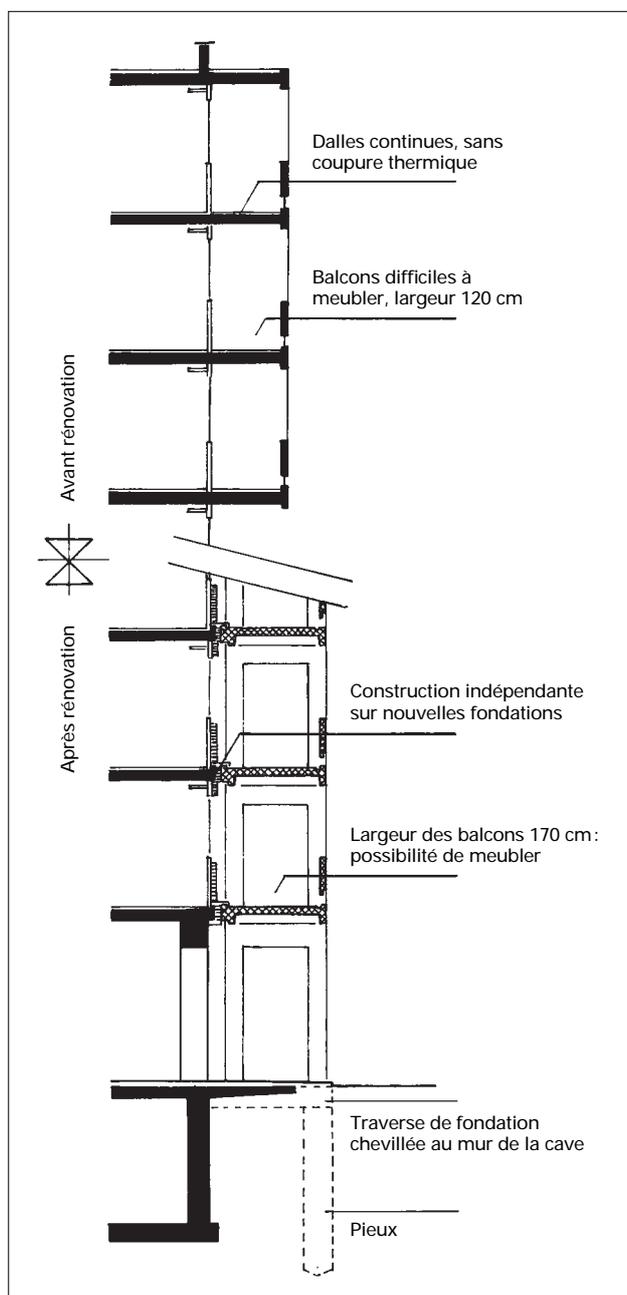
Coupe transversale sur la façade – avant et après rénovation.
